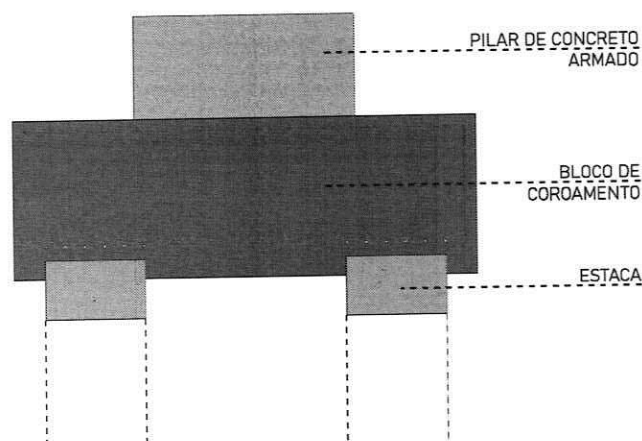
Bloco de coroamento e pilar de concreto armado presentes na fundação do tipo estaca
